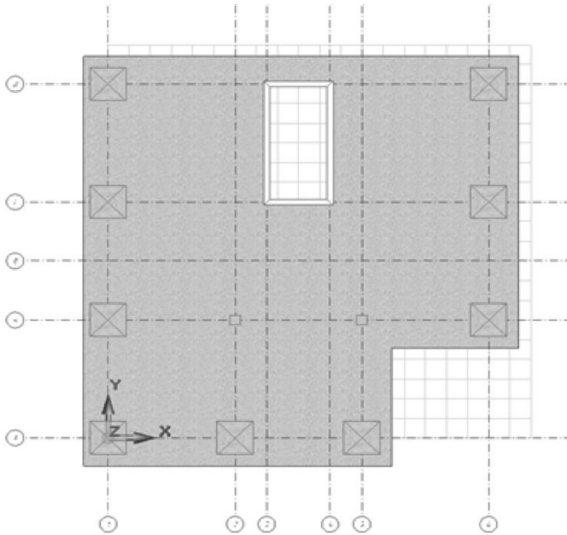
Розташування прорізу в плиті перекриття на вигляді зверху
